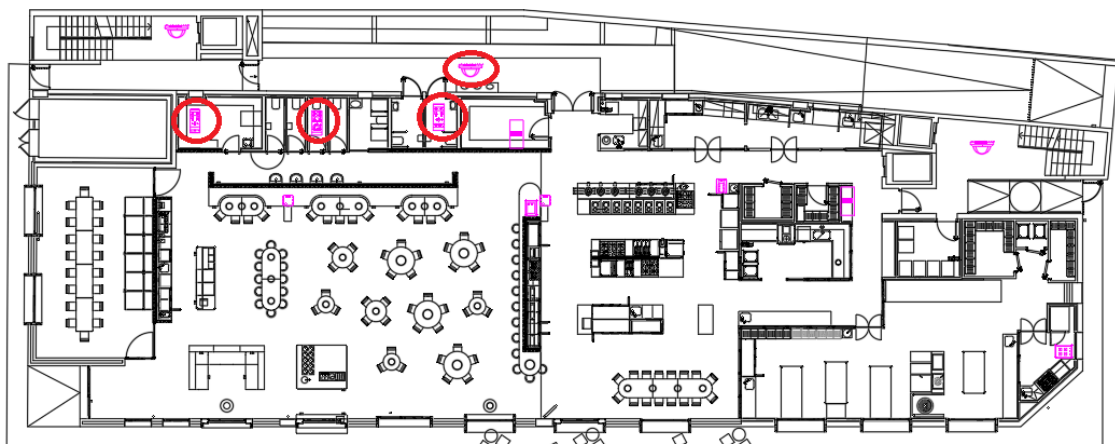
Ubicación dispositivos instalados en los baños de la zona del restaurante.
